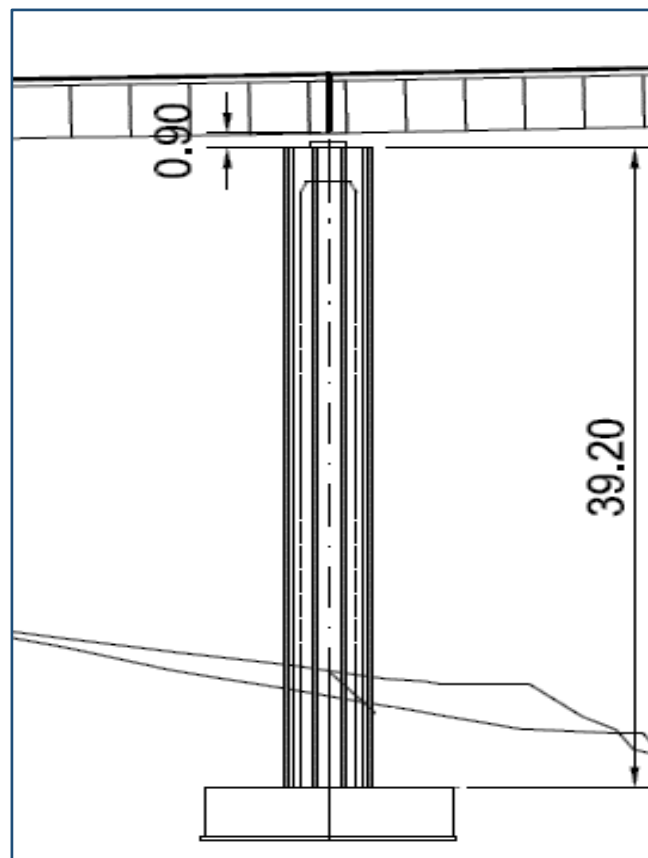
Coupe longitudinale de la pile intermédiaire
